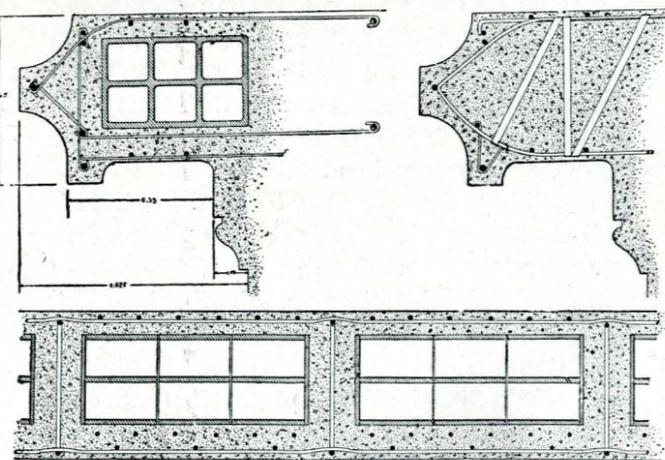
Particolare del cornicione - Sezioni trasversali e longitudinale.
